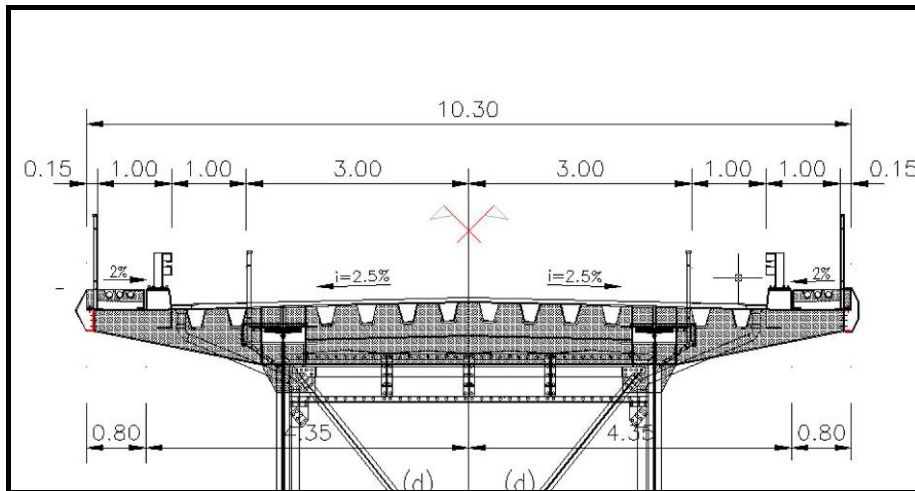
Corte transversal de laje ortotrópica em aço [10]
